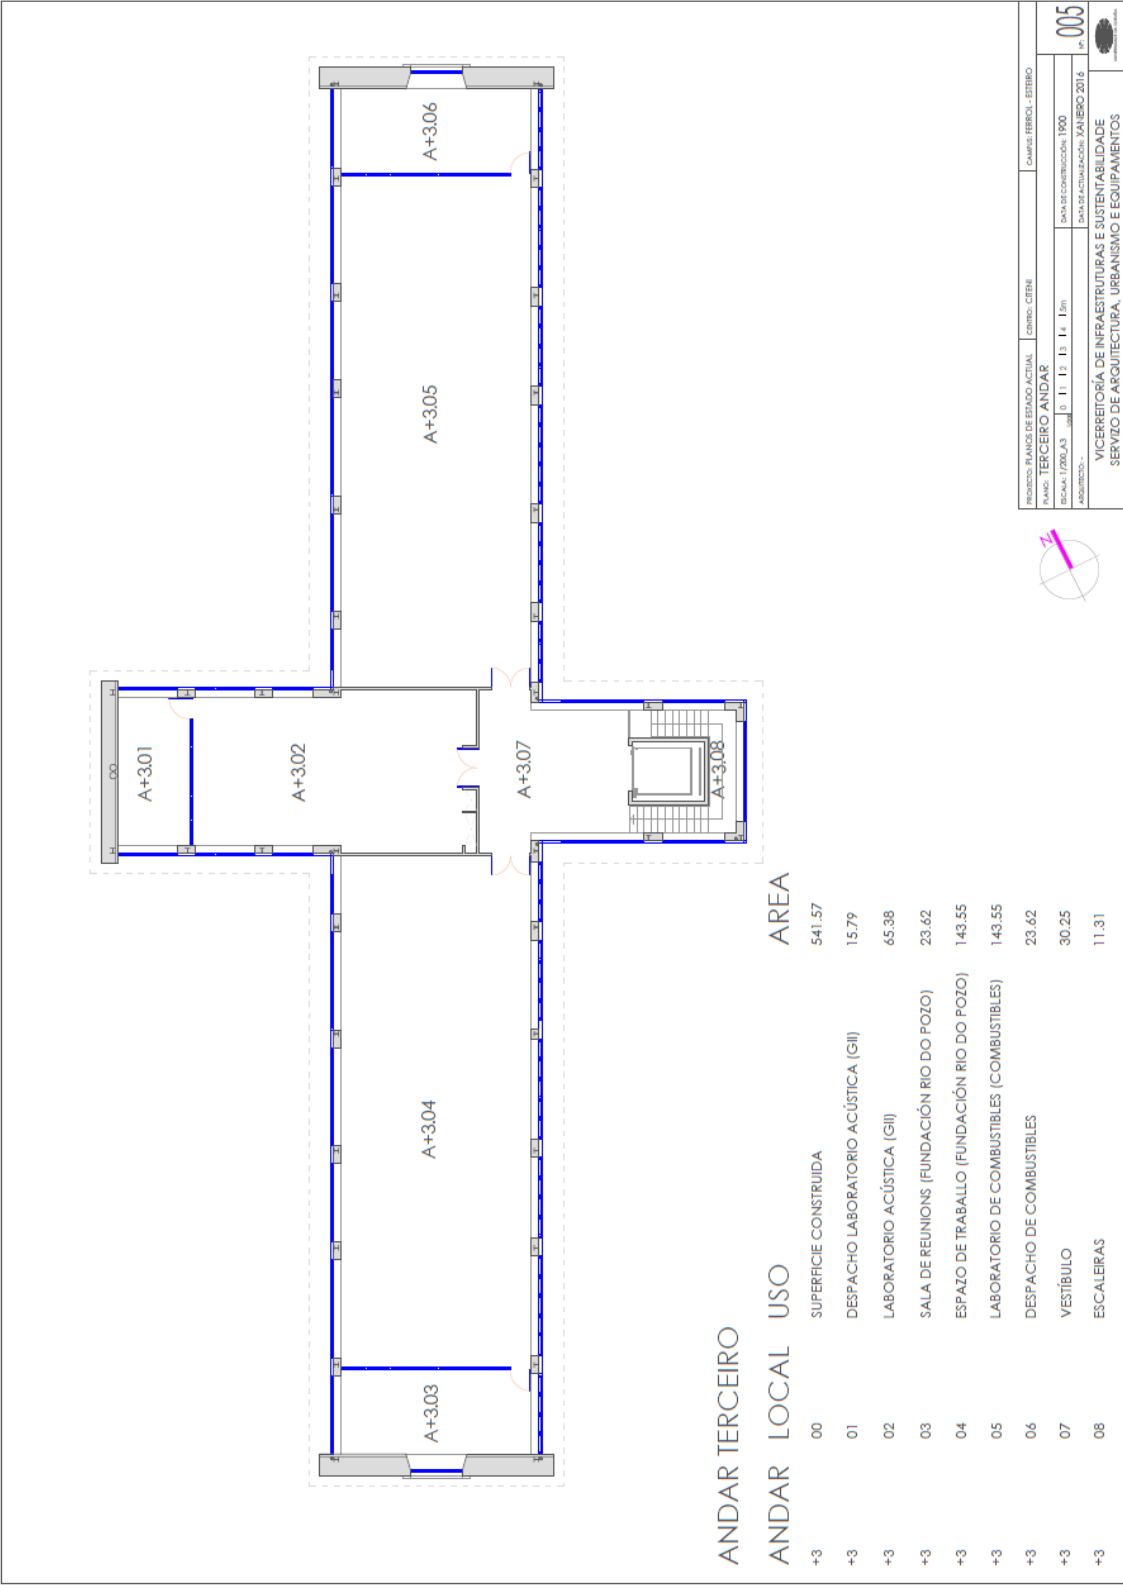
Plano de planta tercera. Fuente: Vicerrectoría de infraestructuras y sostenibilidad.
